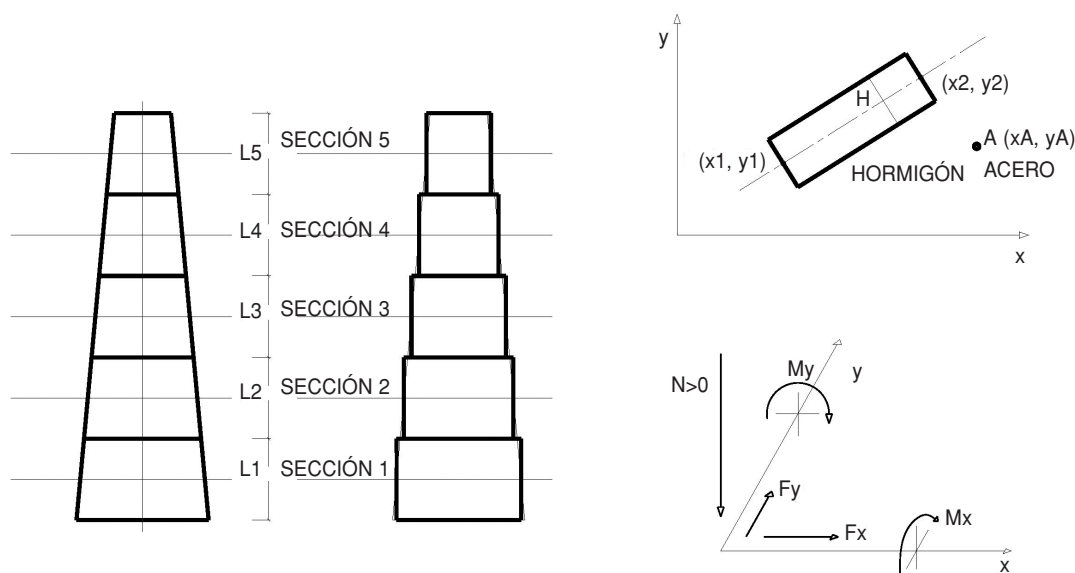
Modelización de la pila y de las secciones y de los materiales hormigón y acero en el sistema local de la sección.
